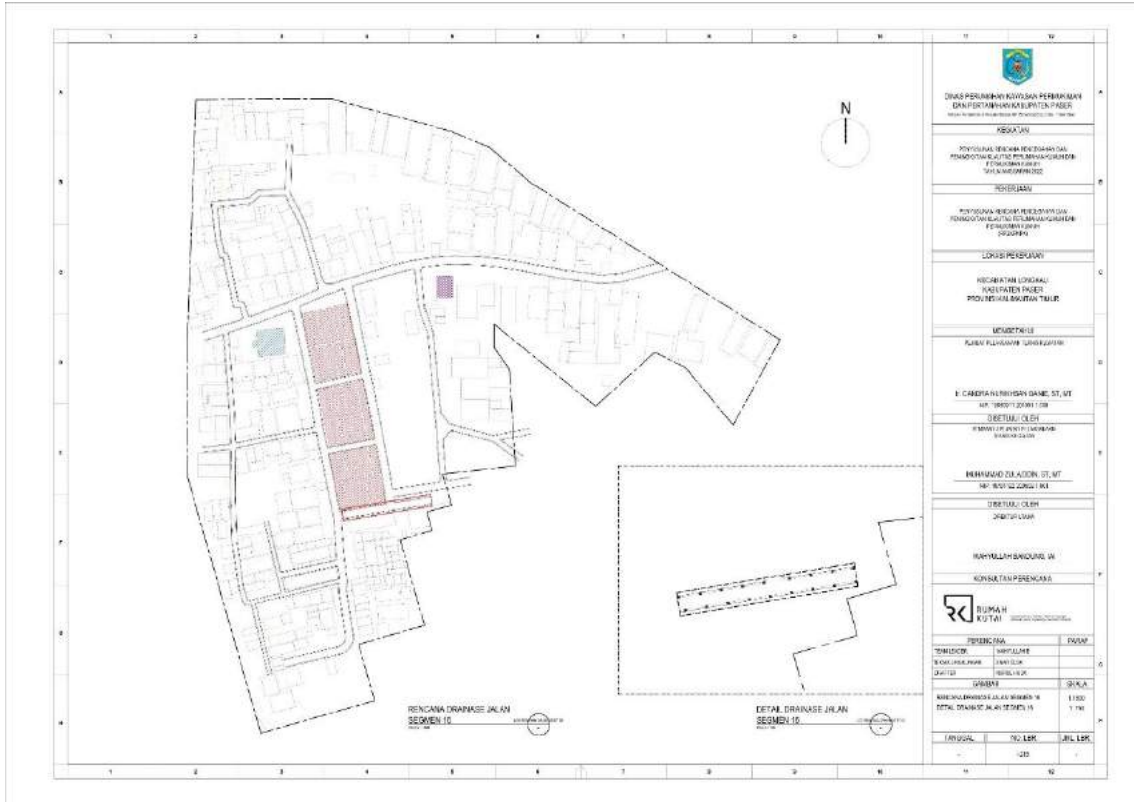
42 Konsep Rencana Drainase Segmen 14 RT.02
